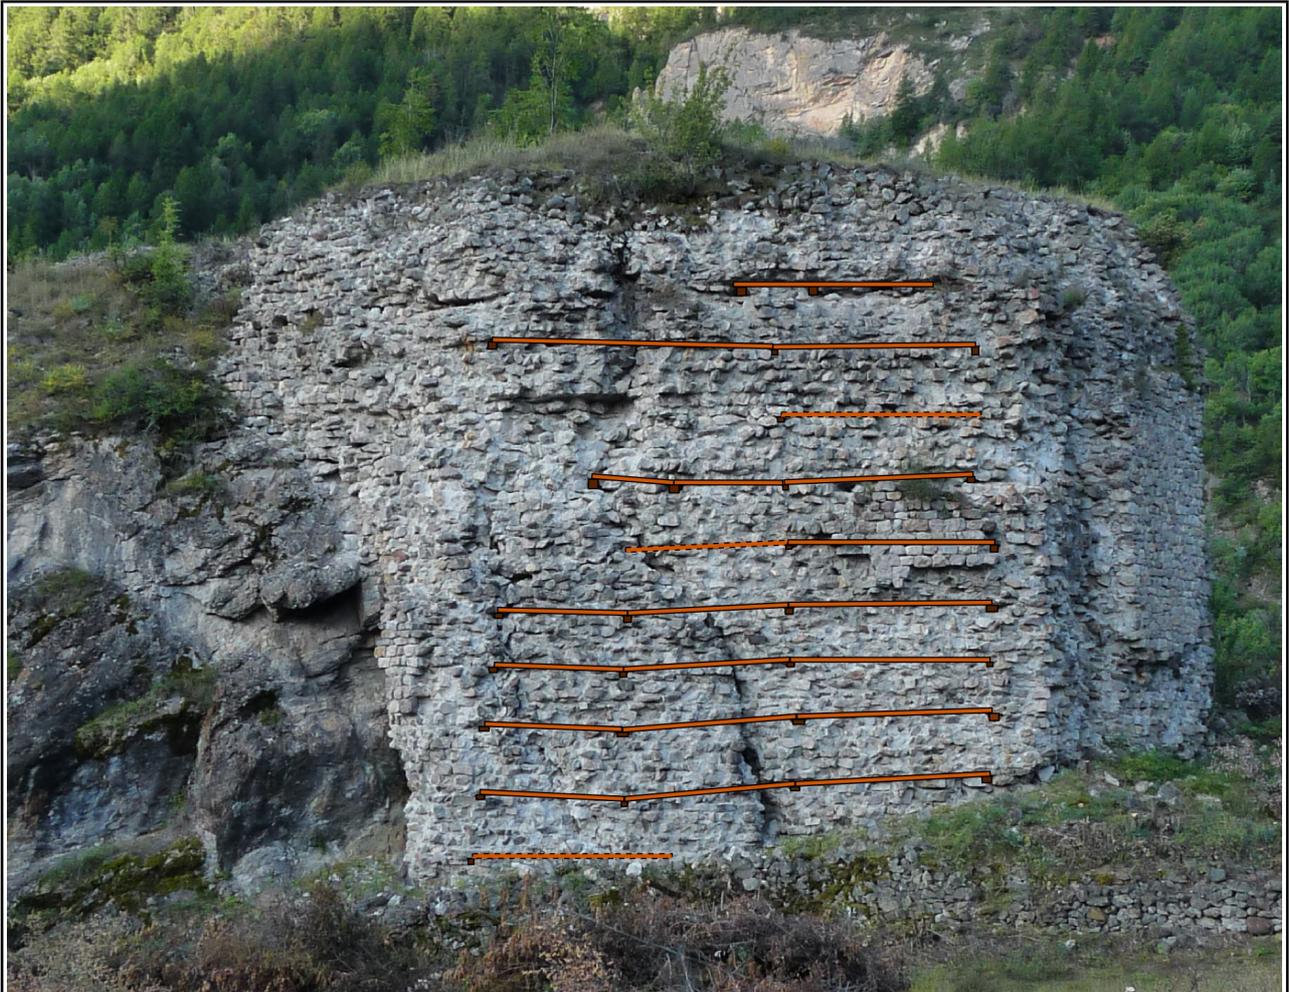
Restitution de l'échafaudage de construction de la maçonnerie de soutènement sur la face 2
